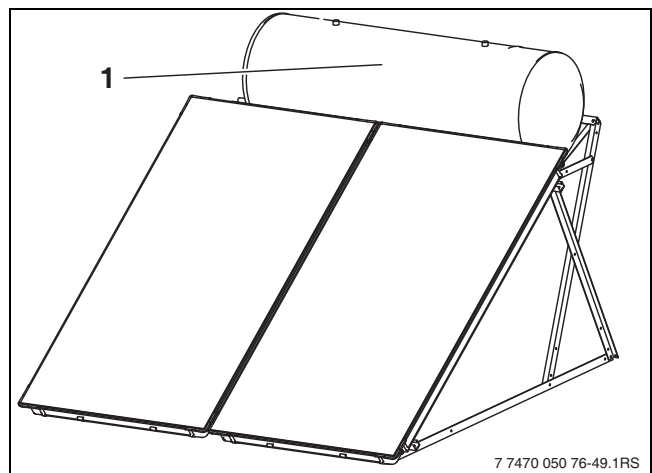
Vista montaje en cubierta plana (sistema de 300 l)
